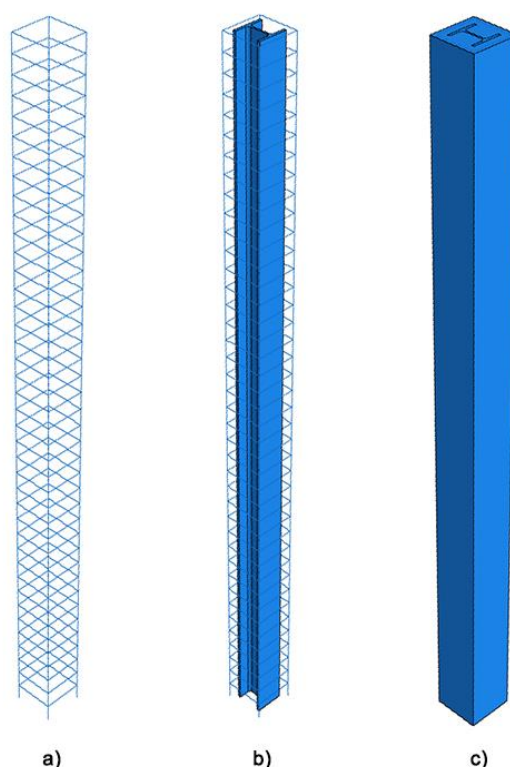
Pasos para la modelación de pilares mixtos de acero embebido en hormigón: a) Armado longitudinal y transversal; b) Perfil metálico; y c) Hormigón.
